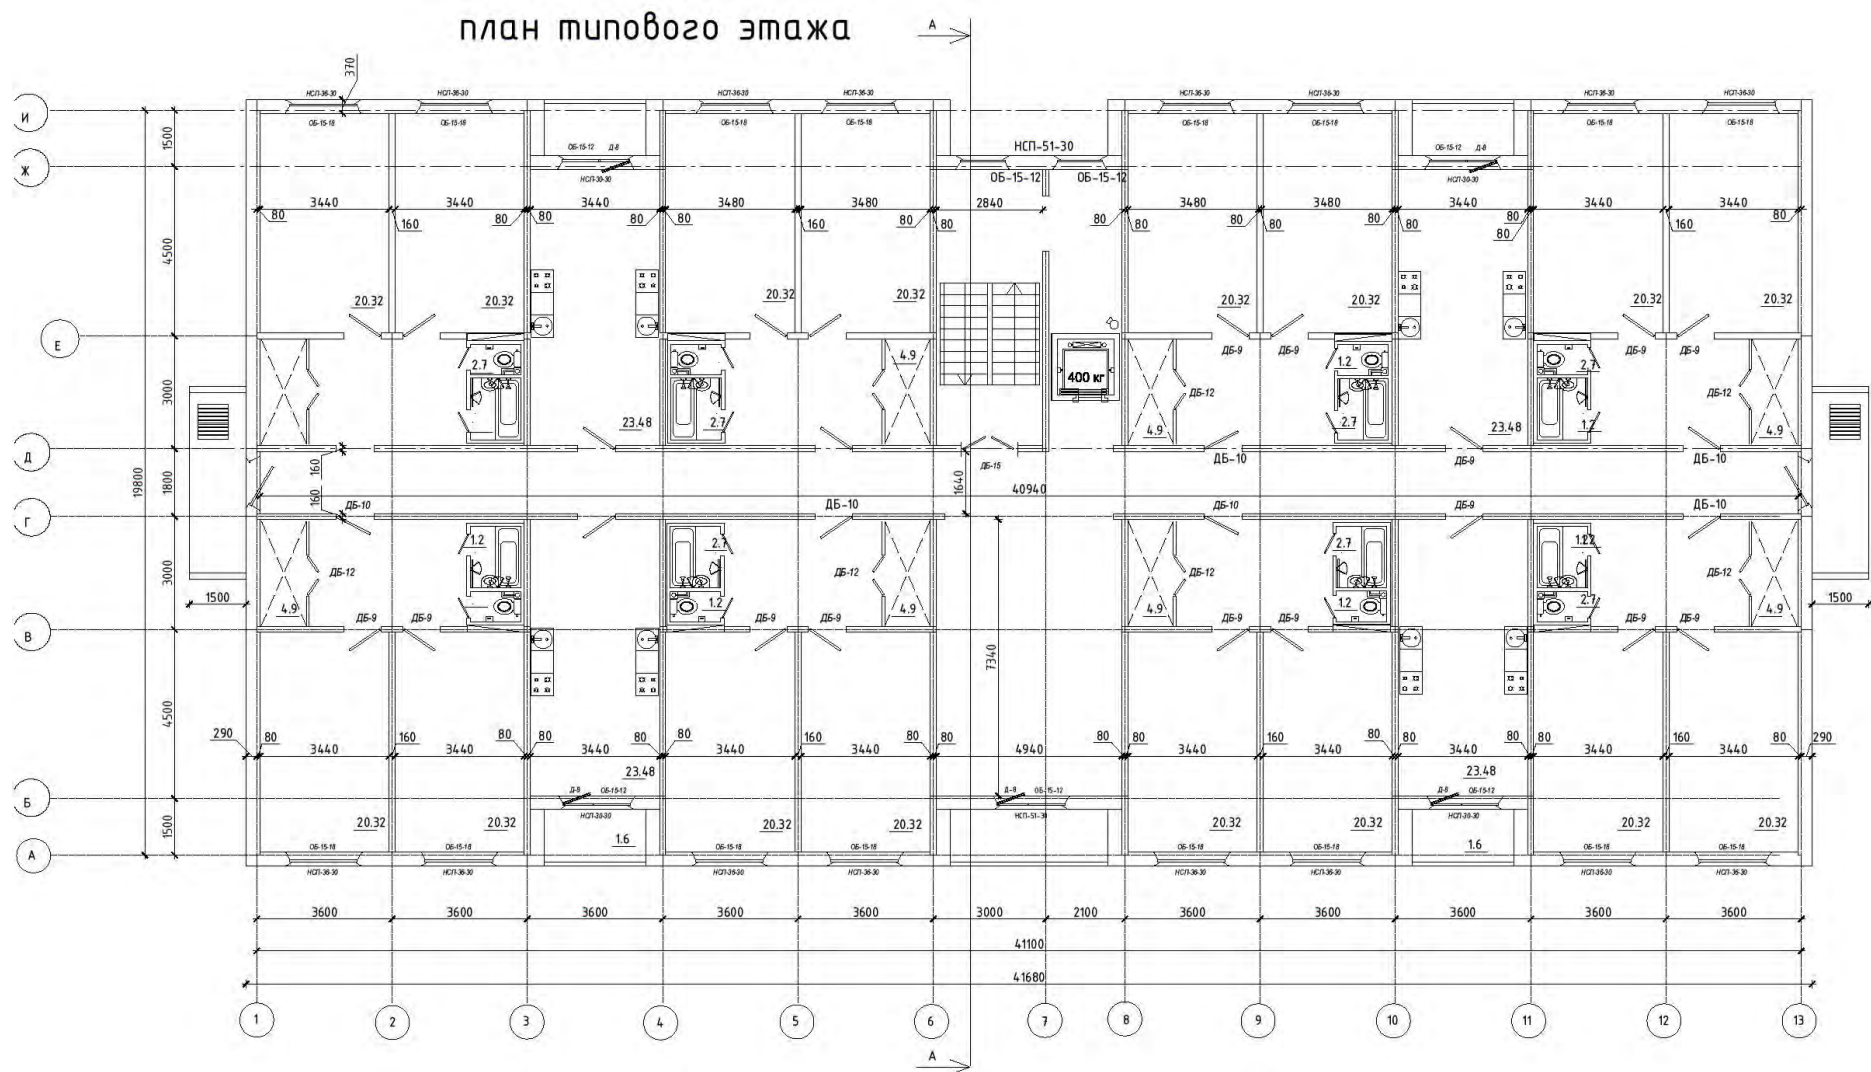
Образец выполнения плана типового этажа жилого здания
